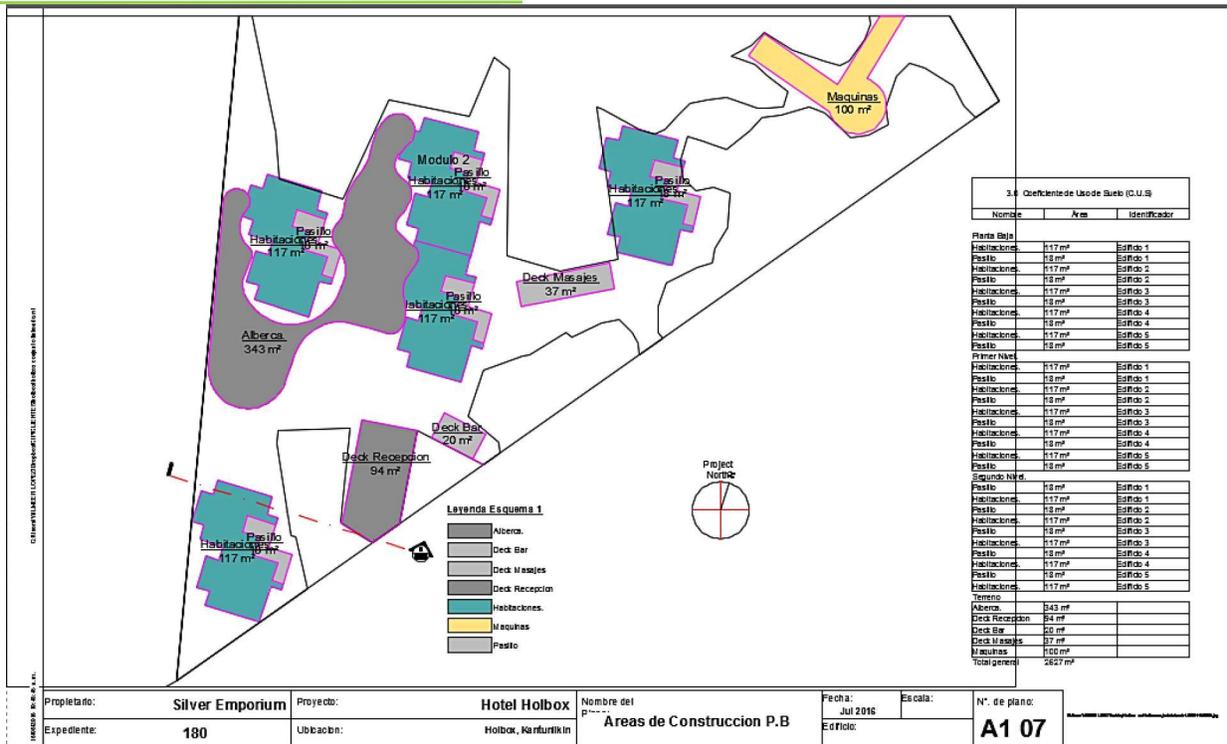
Diagrama del Desplante en Planta Baja del proyecto.
